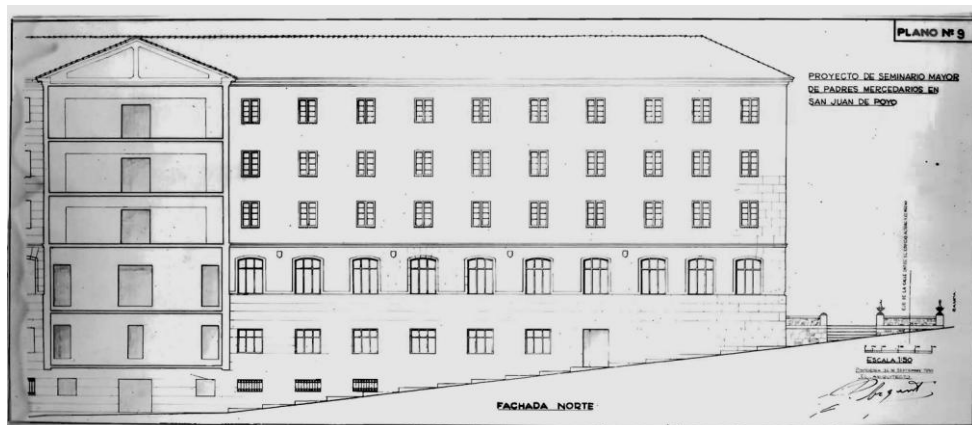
Fachada Norte. Fuente: Archivo Provincial.
